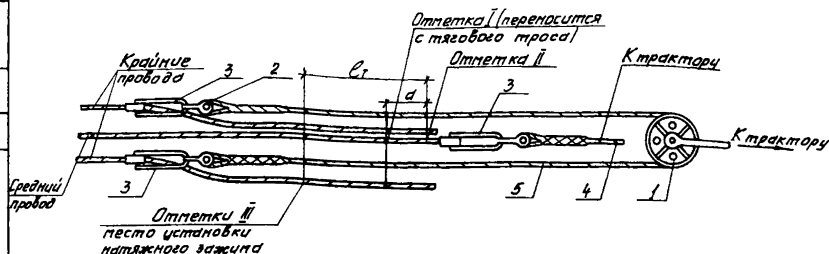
Схема нанесения отметок на проводах при вьшробании с подъемом на анкерно-углубную опору
